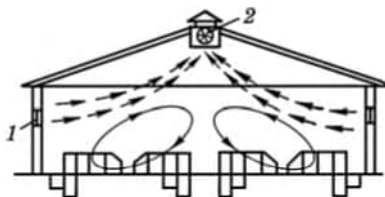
Схема вытяжной вентиляции животноводческого помещения:
